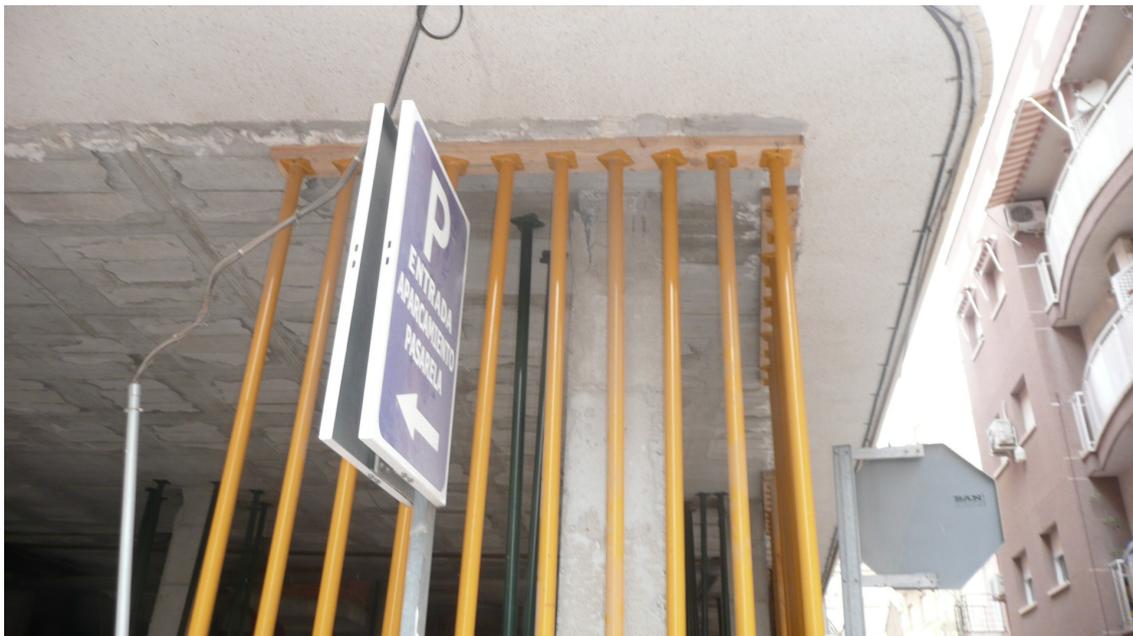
Diseño de apeo de pilar y su protección. Lesión en cabeza de pilar con desprendimiento de hormigón. Se ha procedido a su apuntalamiento o apeo porque esta lesión puede conducir a un tipo de colapso frágil del edificio. Además, el apeo realizado es apto para realizar trabajos de refuerzo en cabeza de pilar. Situado en C/ Turbintos, de Lorca.
